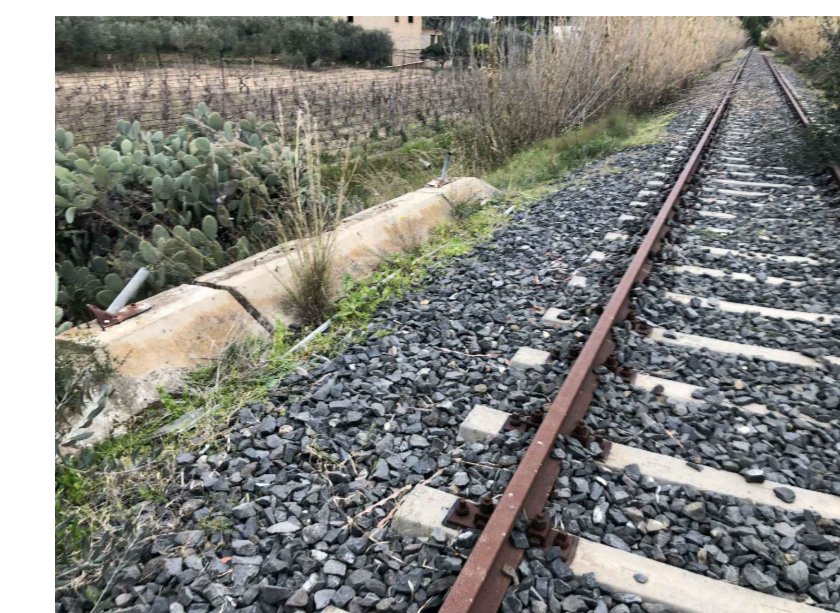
DEGRADO - ASSENZA DI PARAPETTO - LATO MONTE
